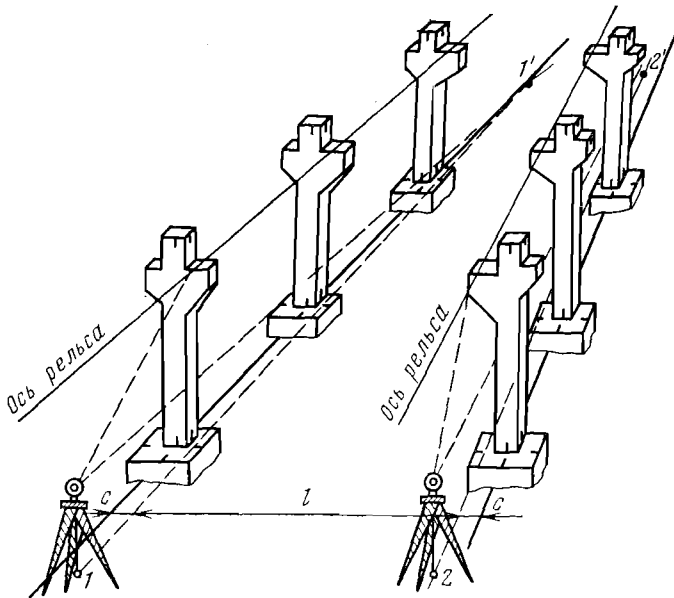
Схема геодезических работ при монтаже подкрановых путей
